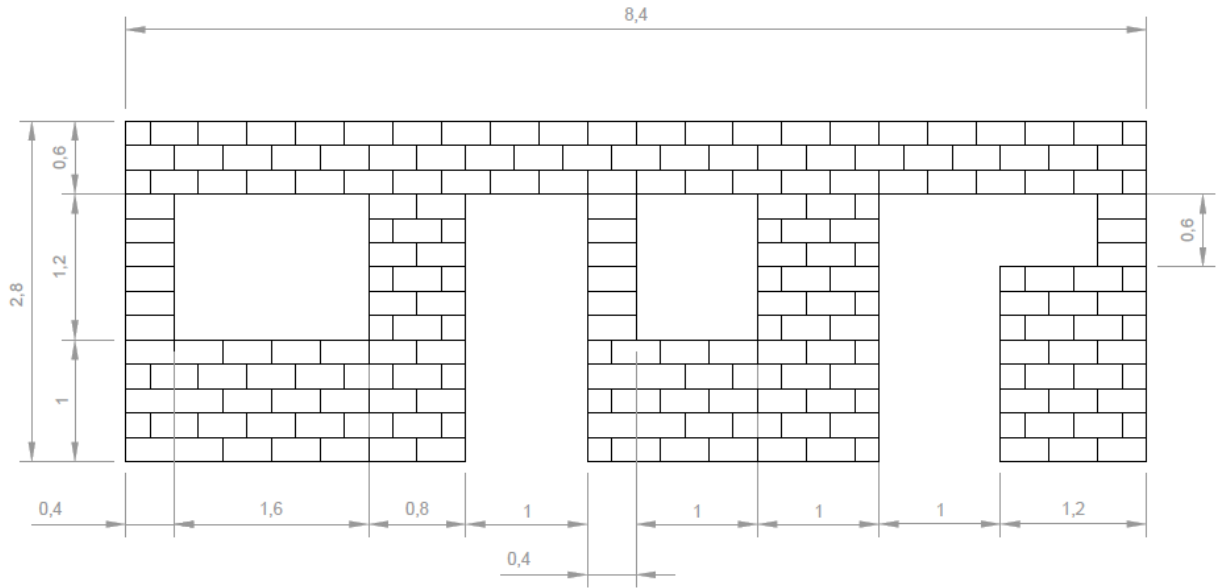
Modulaci3n de bloques de mampostería en el espécimen estudiado
